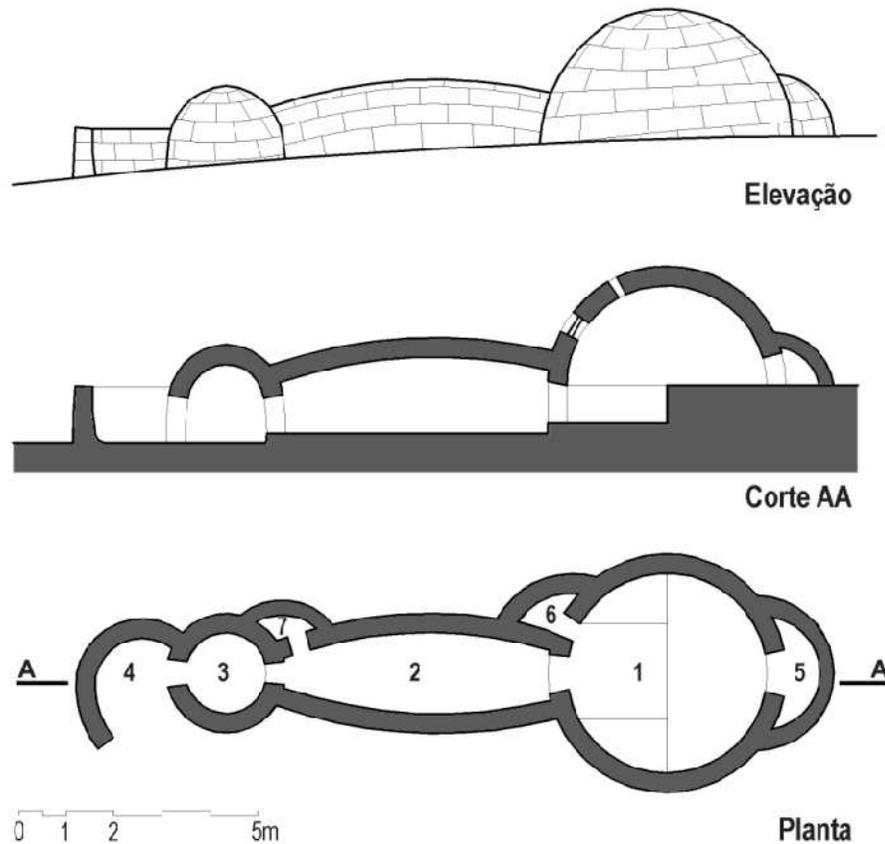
Elevação, corte e planta do iglu segundo Schoenauer.
